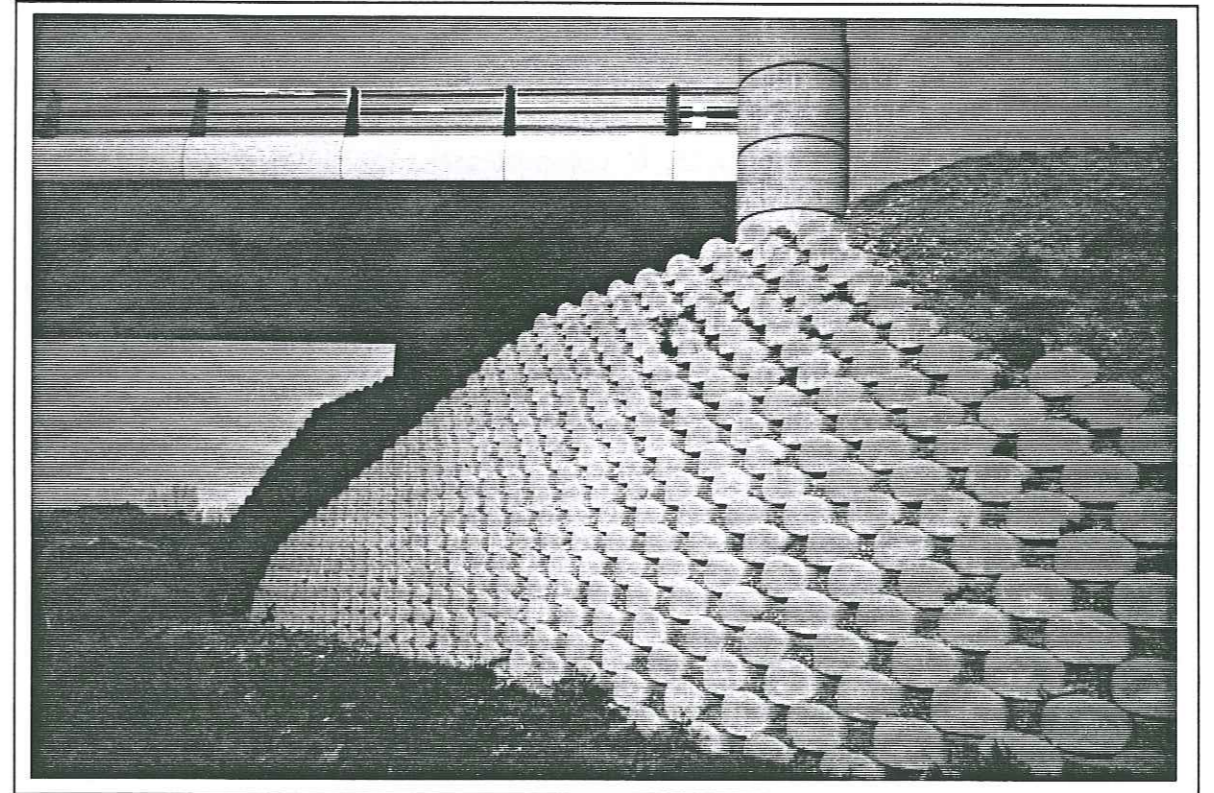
Culée de pont dont l'habillage est un massif en terre renforcé, à parement cellulaire (pierres Löffel)
